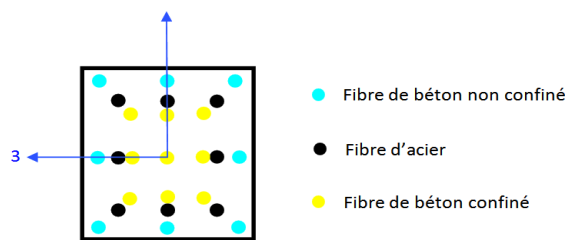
Modèle de fibre de la section transversale du poteau (2C1)
